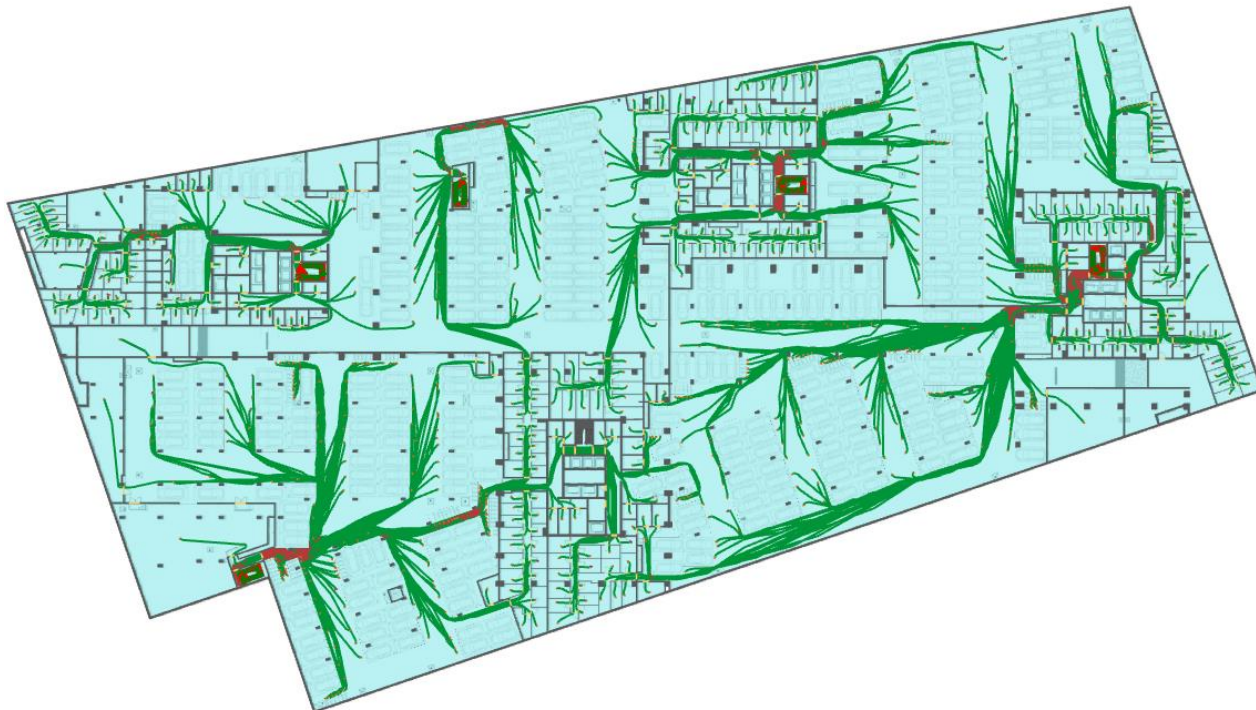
План минус 2-го этажа и нанесенная на него расчетная (принципиальная) схема эвакуации
